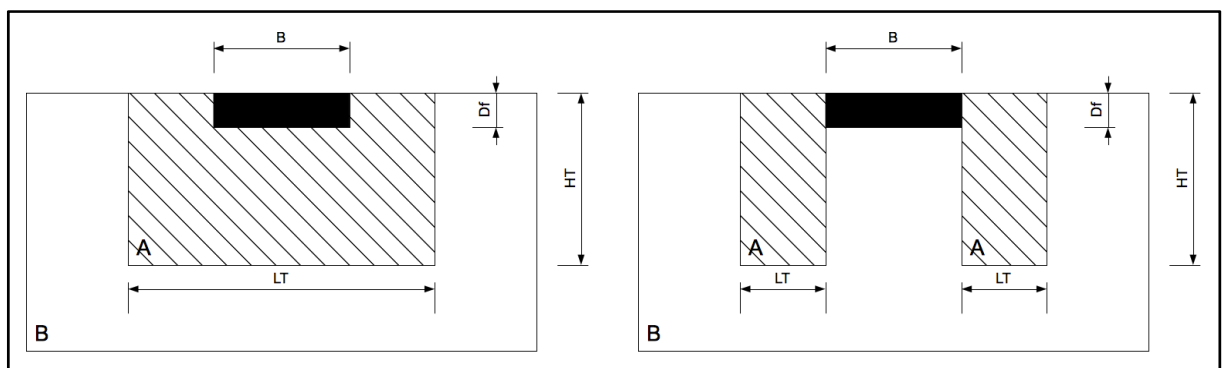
Dimensions de zones traitées dans le cas d'un traitement avant construction de la semelle (a) et dans le cas d'un traitement de réhabilitation (b)
